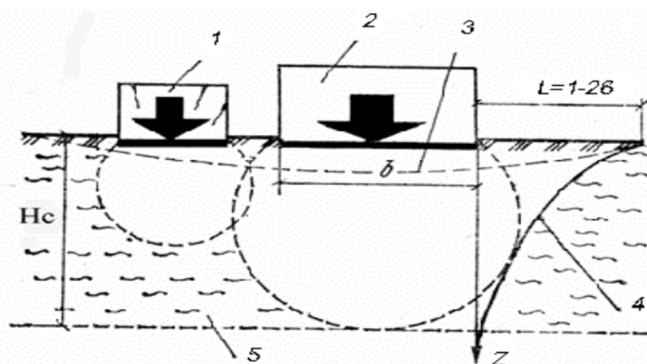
Осад поверхні ґрунту: 1 – існуюча будівля; 2 – будівля що зводиться; 3 – зона осаду; 4 – епюра осаду; 5 – сильно стискуваний ґрунт
